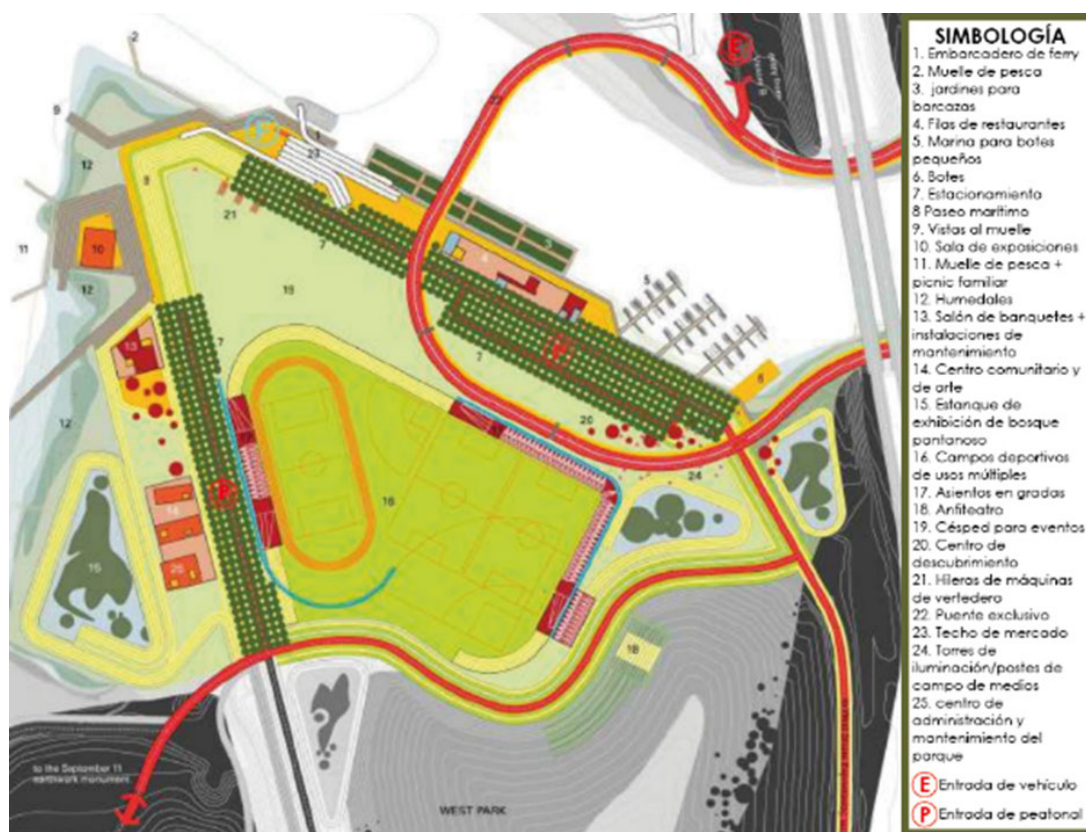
Planta el punto. Fuente: Borrador del plan maestro, 2006.
